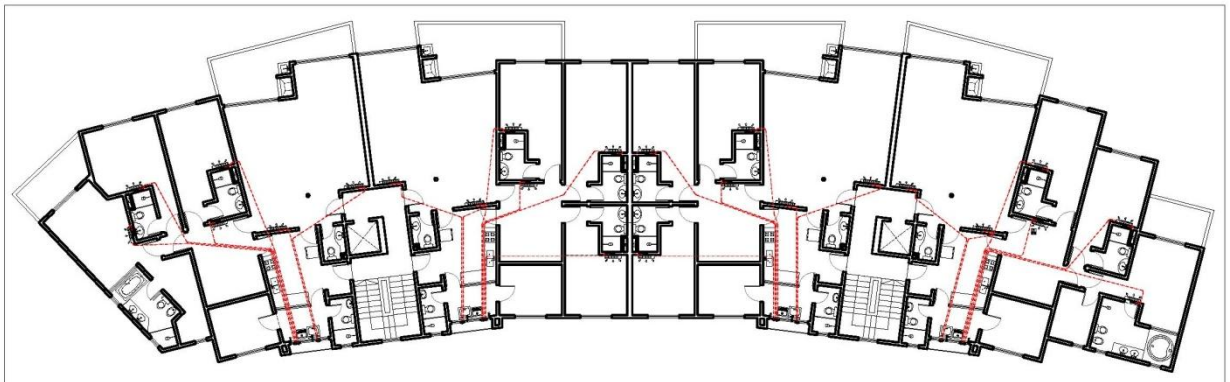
Planta baixa do projeto de ar-condicionado do pavimento tipo do bloco 02.
